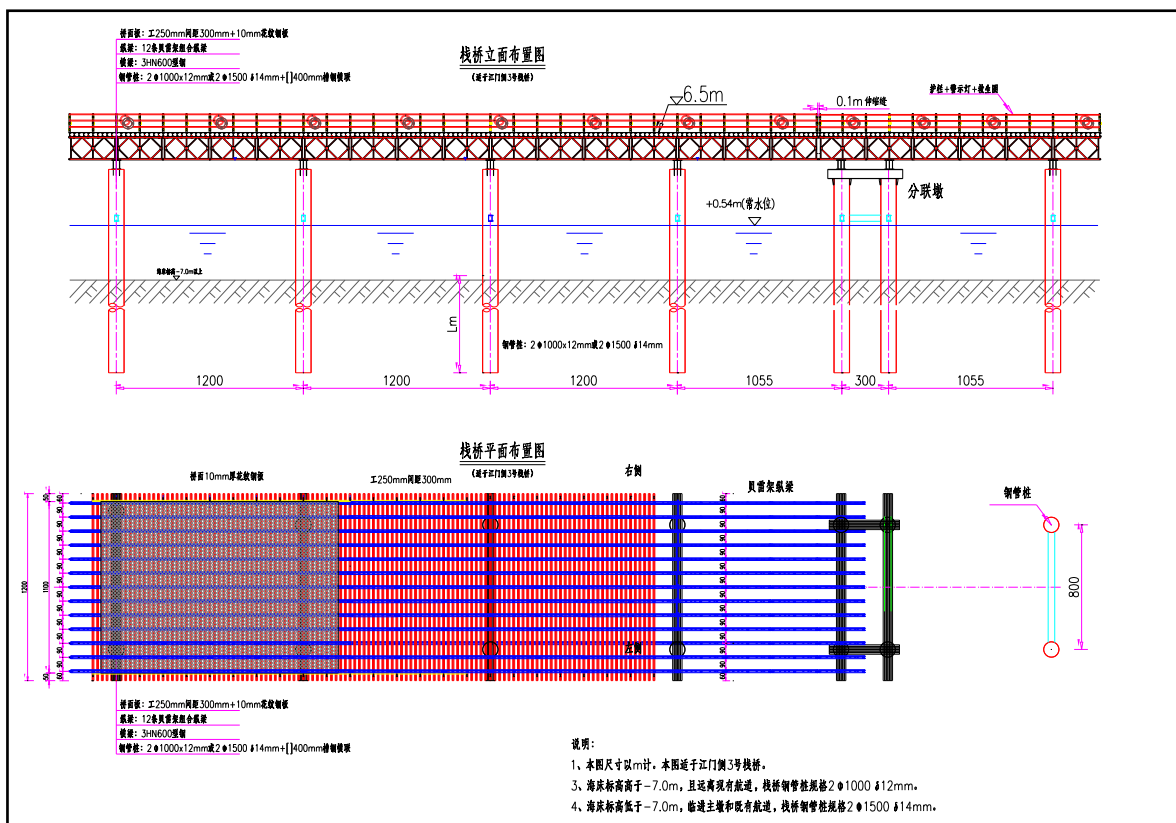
江门侧 3 号栈桥纵向平面、立面一般布置图 (桥宽 12m)
